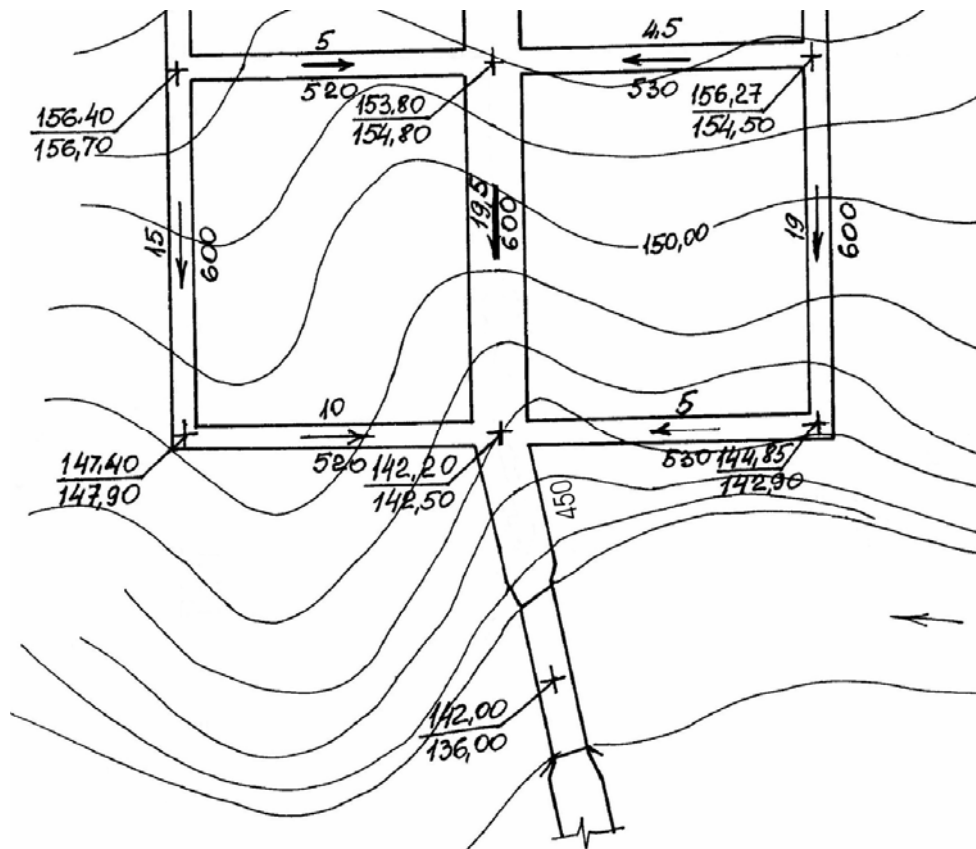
Фрагмент плану з червоними позначками і поздовжніми ухилами
